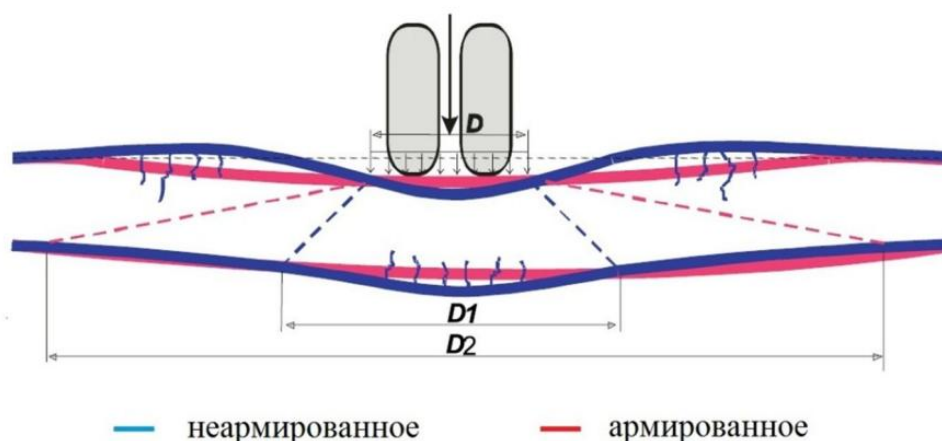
Асфальтобетонное покрытие под колесной нагрузкой
